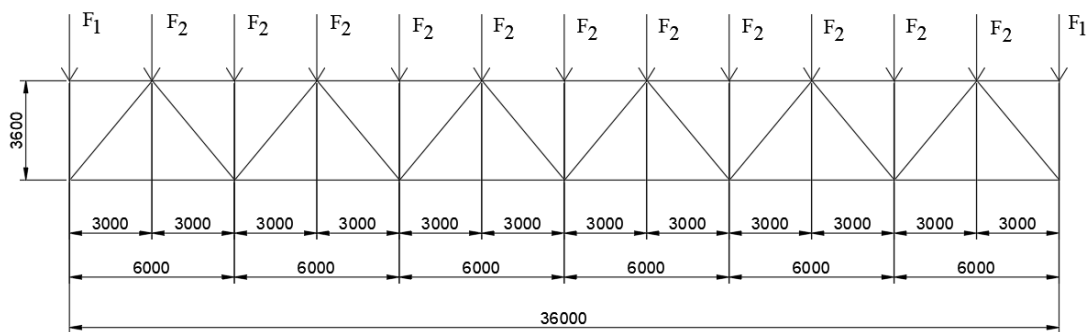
Розрахункова схема ферми прольотом 36 м
